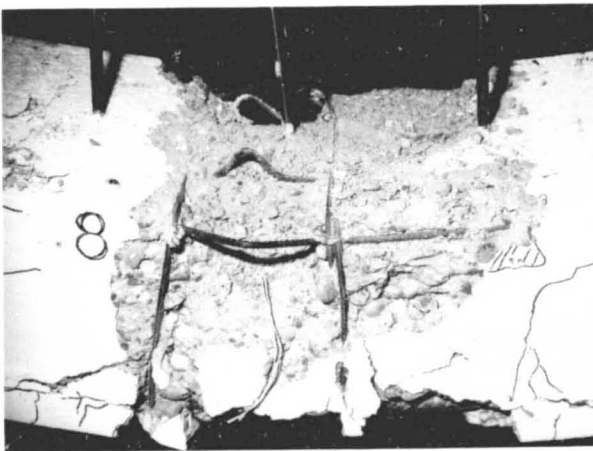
Detailaufnahmen nach dem Versuch B8.2
